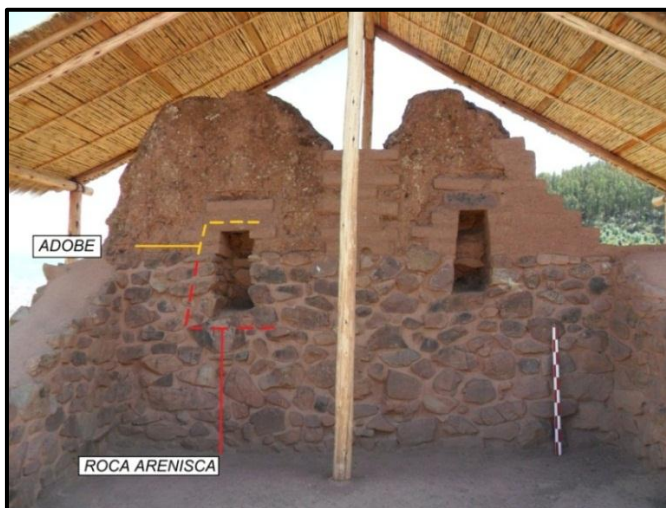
Se aprecia dos hornacinas trapezoidales paralelas, construidas con roca arenisca y adobe. (Fuente Propia)
